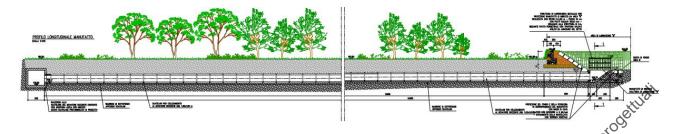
profilo longitudinale Scarico area di laminazione B. Estratto da Tav. 13.2
